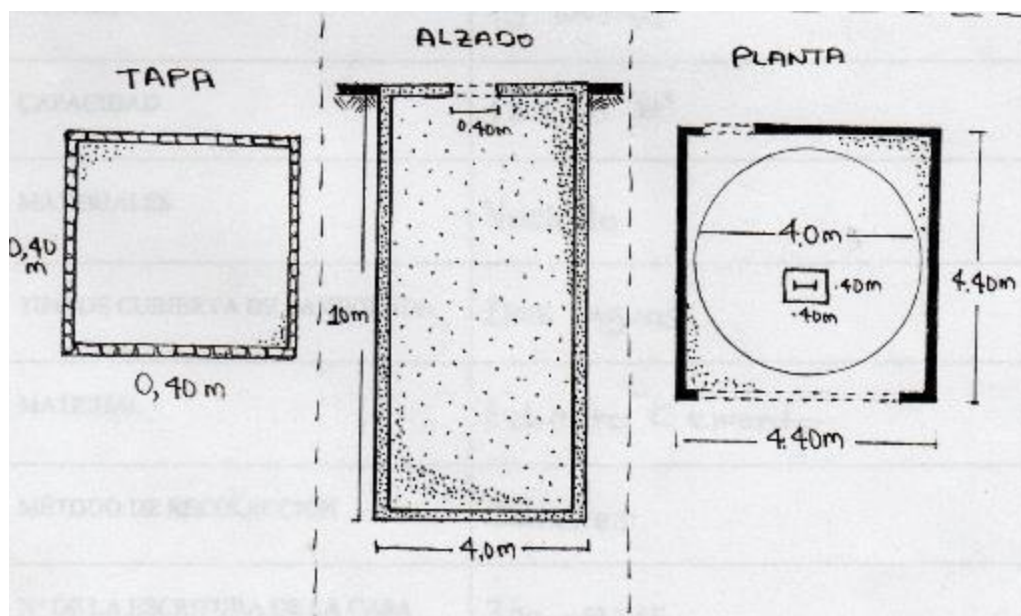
Detalles y Alzado de Elementos del Dispositivo Flia. Pones
